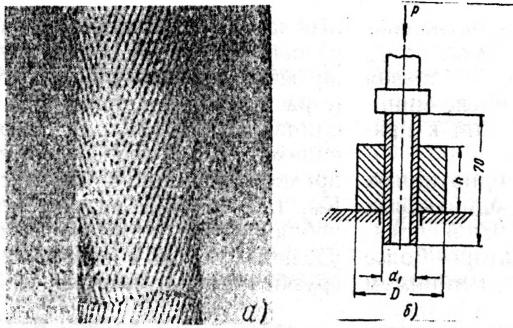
Определение напряжения сдвига $\tau_{сдв}$ в усадочном соединении: а – отпечаток поверхности арматуры в месте соединения; б – схема испытания.
